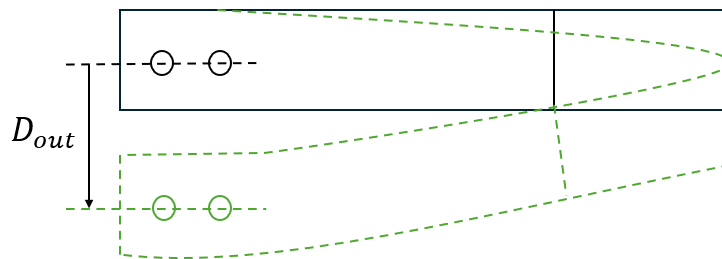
Vista en plano del dispositivo *U-Shaped* bajo carga fuera del plano (P_{out}). La línea discontinua muestra la configuración deformada, destacando el desplazamiento máximo D_{out} .
